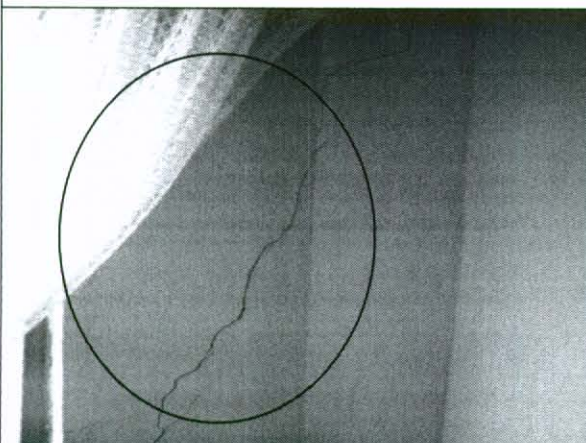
Estado de fisuración moderado en muros interiores.
